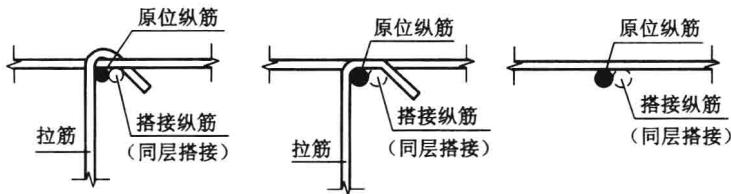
剪力墙分布钢筋处的钢筋搭接位置
